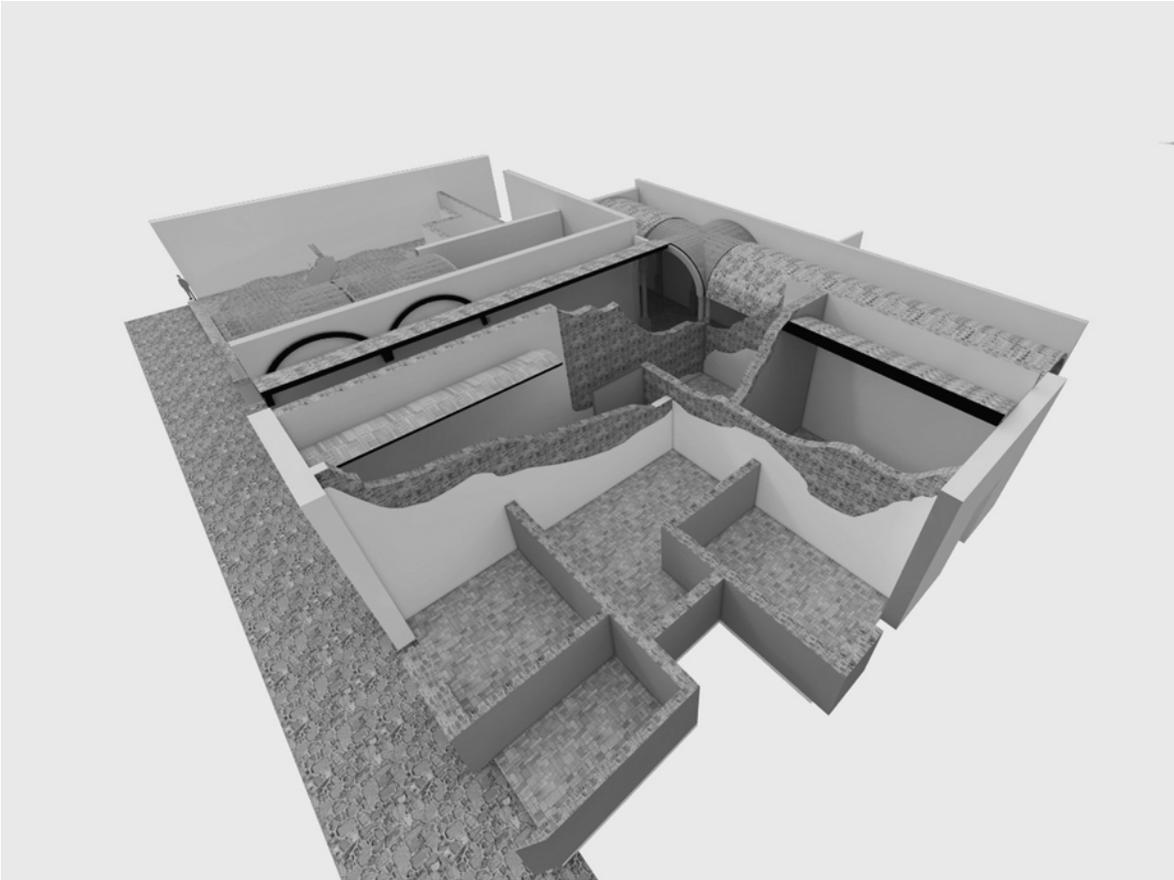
3D del plano ubicación de elementos arquitectónicos.
